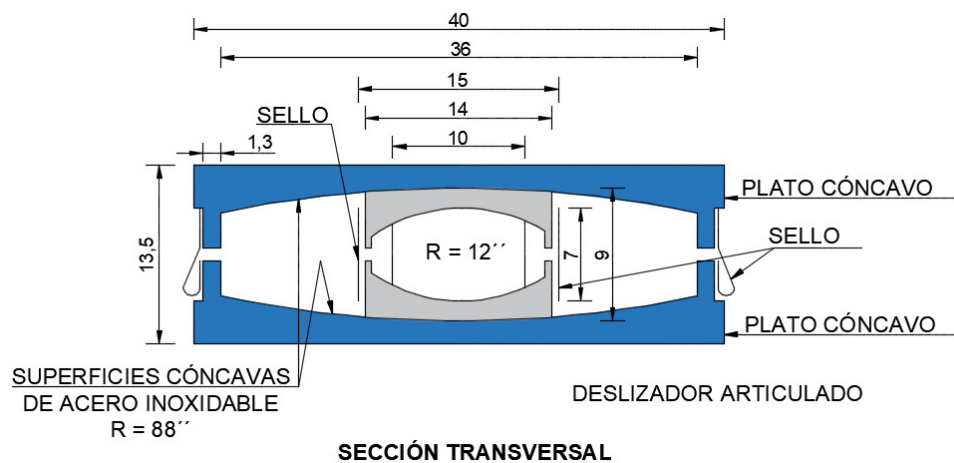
Corte de Sección de Aislador Sísmico empleado en el Puente “Los Caras”
